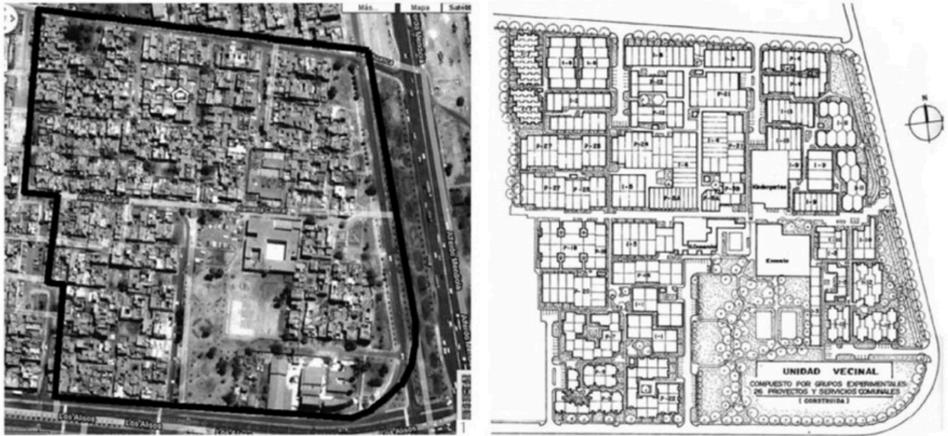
PREVI, 1970 (izquierda). Planta de Proyecto PREVI, 1967 (derecha).
